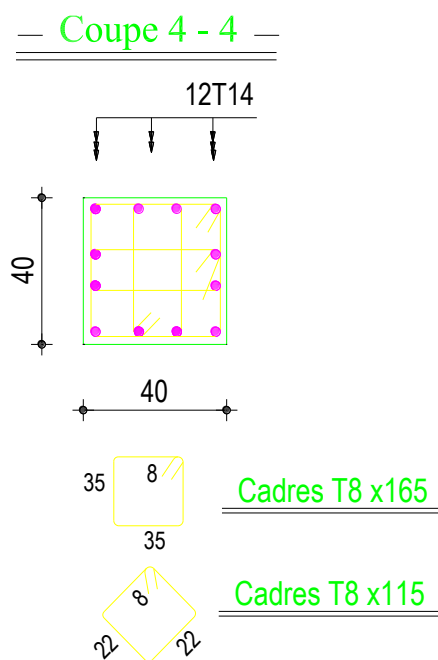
Exemple de ferrillage d'un poteau (40×40)
